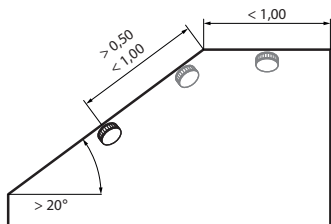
gerade Montagefläche weniger als 1 m lang und 1 m breit
